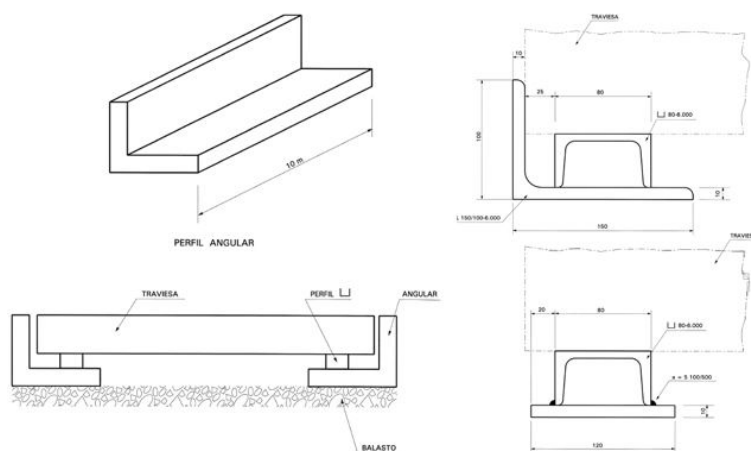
Esquema de disposición de los rastreles de apoyo de las traviesas
